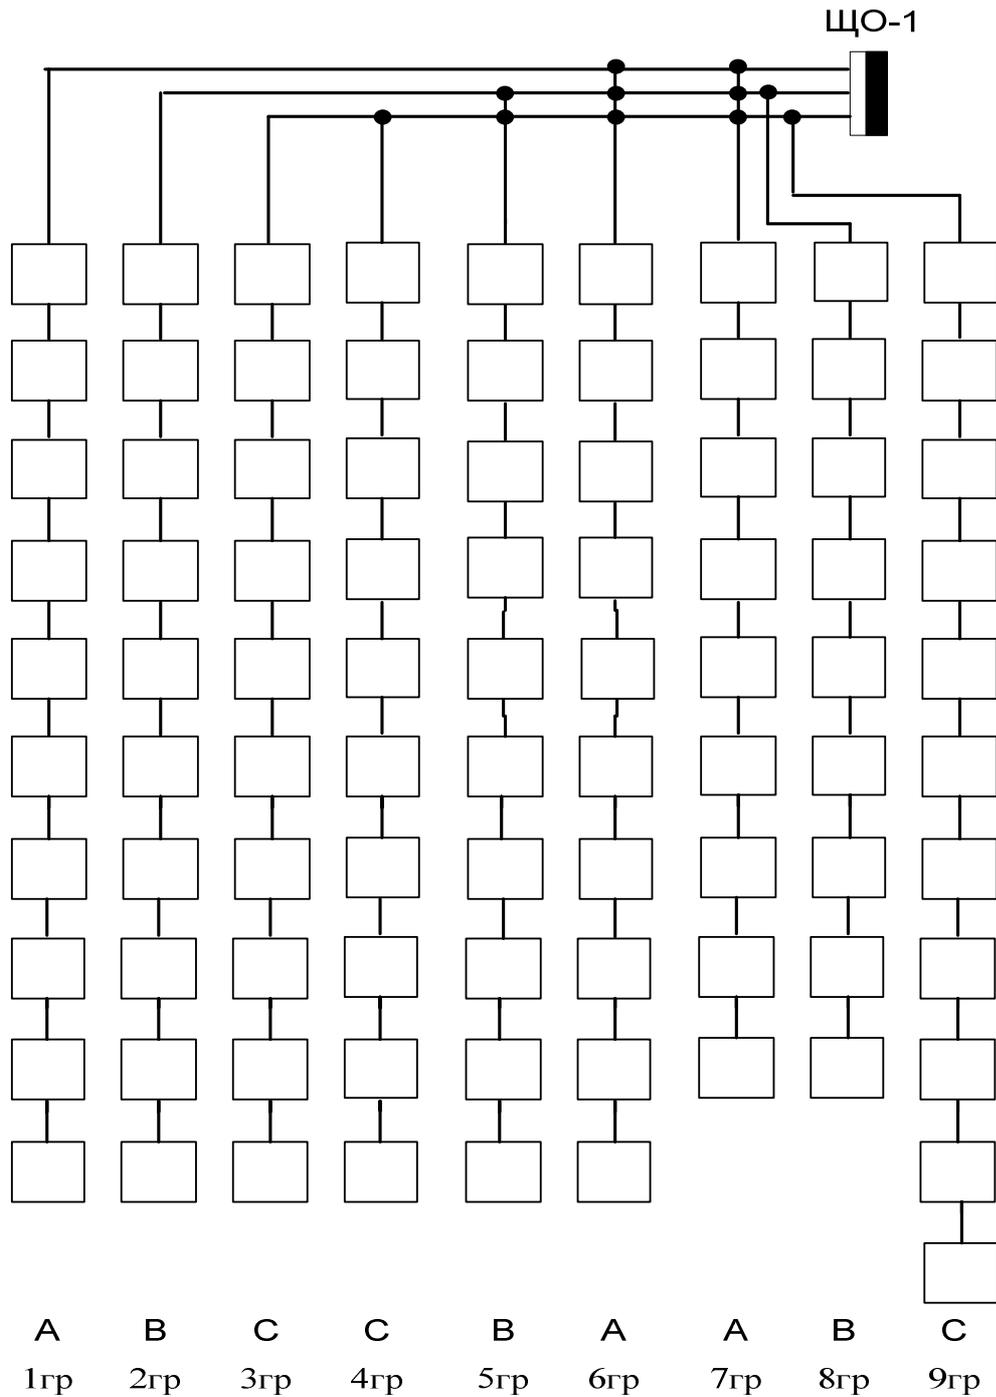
План разводки осветительной сети ЩО-1
